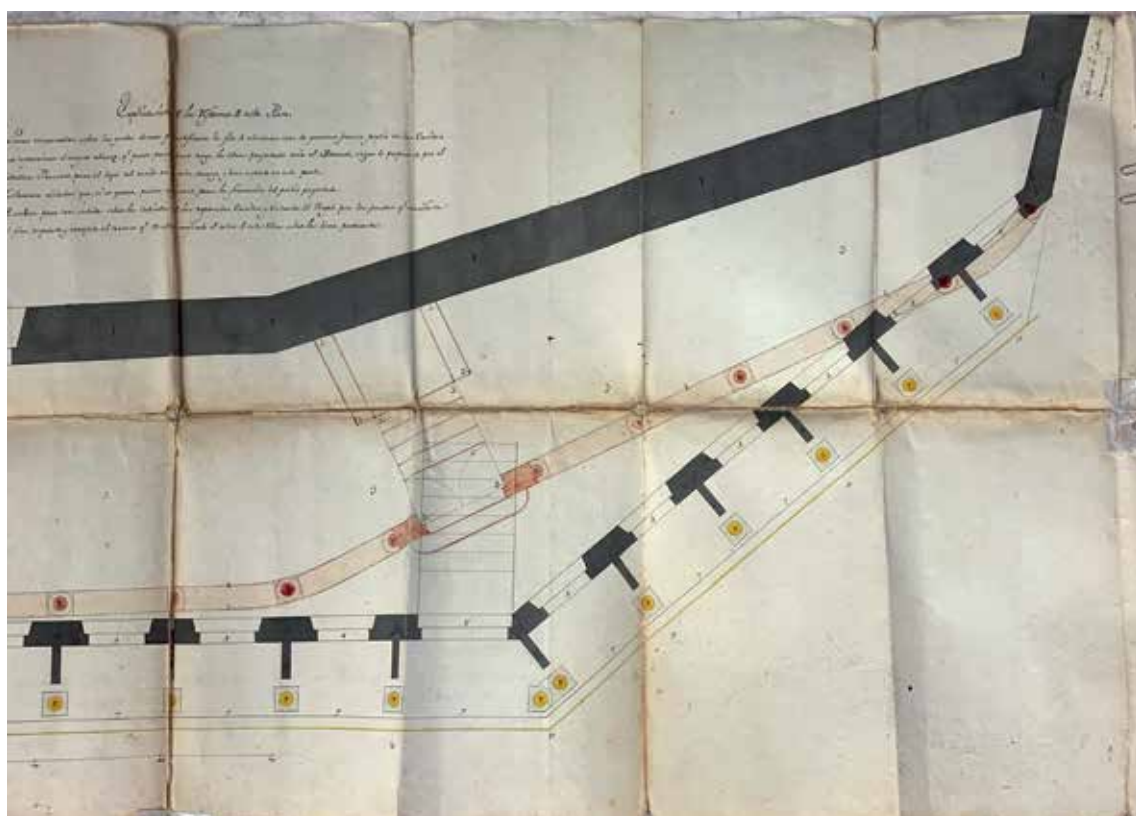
Detalle del plano levantado en 1790 con la doble alineación del diseño primero y segundo del pórtico.
